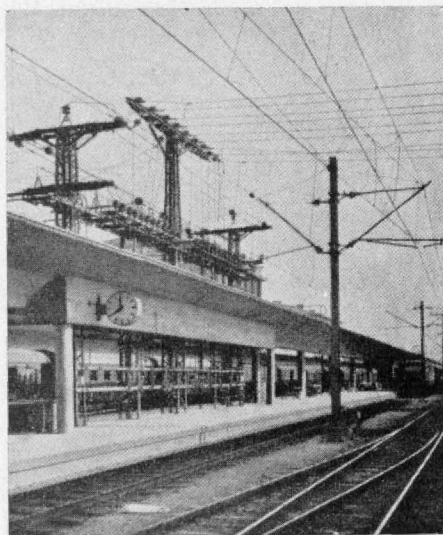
Einheitsfahrleitung mit Vierkant-Betonnäpfen und Schaltgerüst im Linzer Hauptbahnhof.
